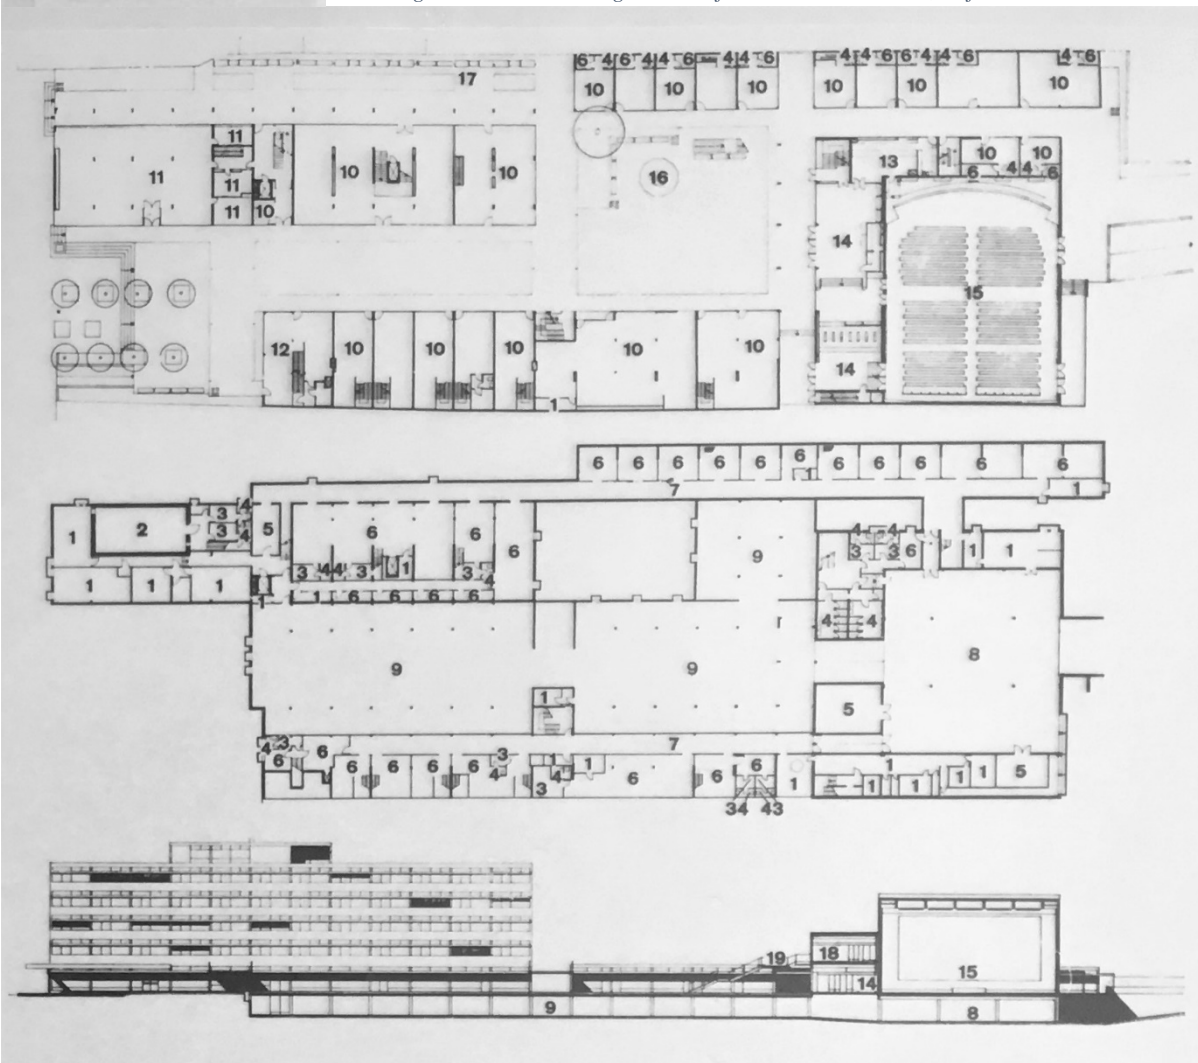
Ekazent Hietzing, von oben: Grundriss Erdgeschoß, Grundriss Untergeschoß, Schnitt, 1961-1964
